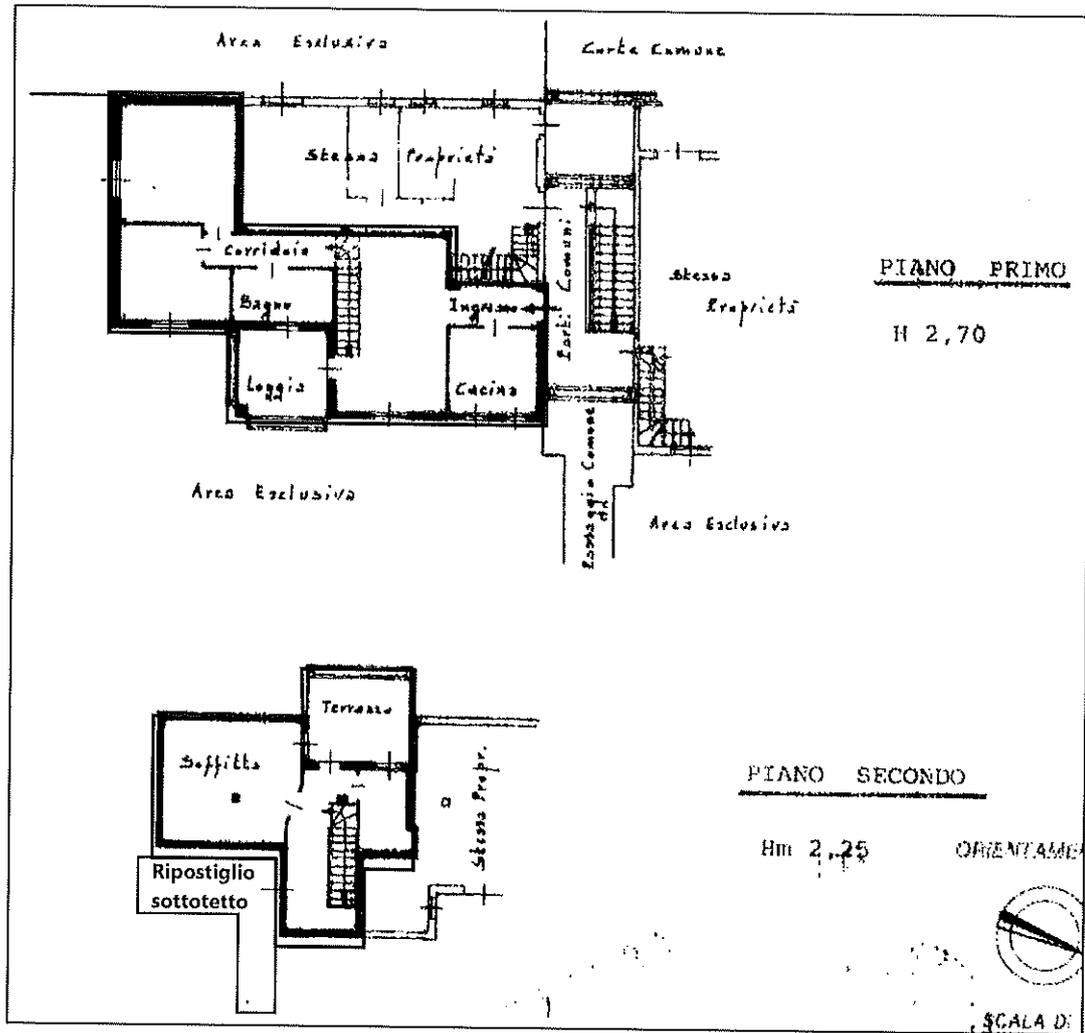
Estratto della planimetria catastale con l'indicazione del ripostiglio sottotetto
